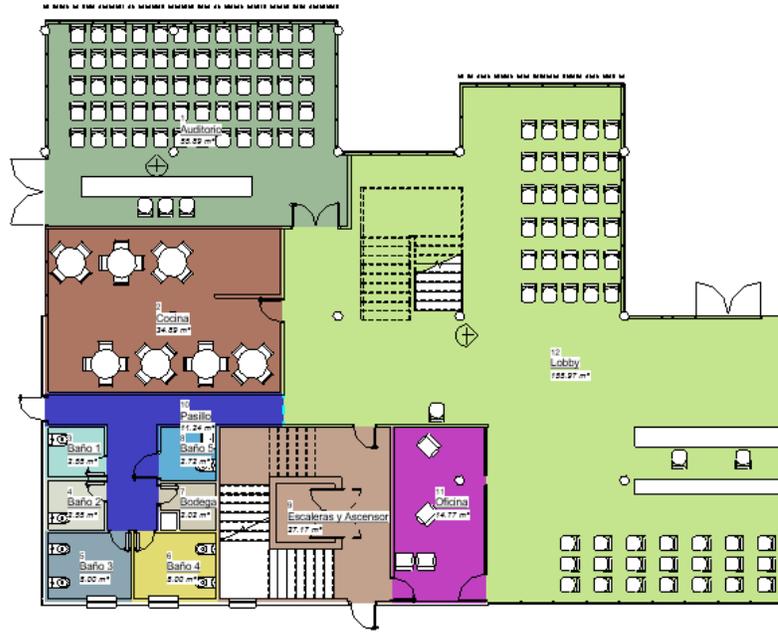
Detalle vista en planta con habitaciones. 1er piso modelo Centro de Salud.
